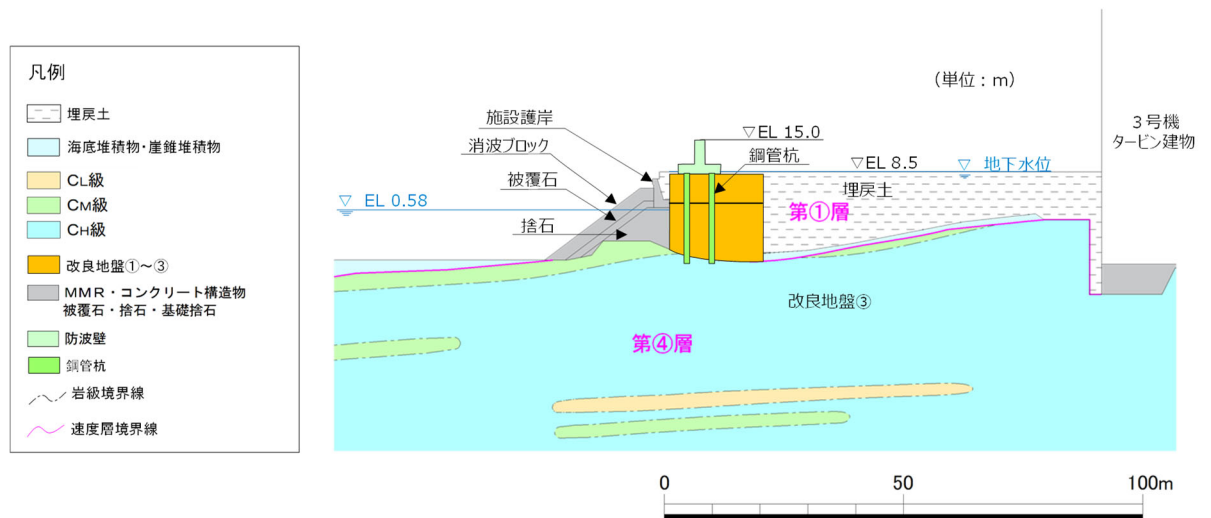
影響検討断面の地質断面図（⑤-⑤断面）
